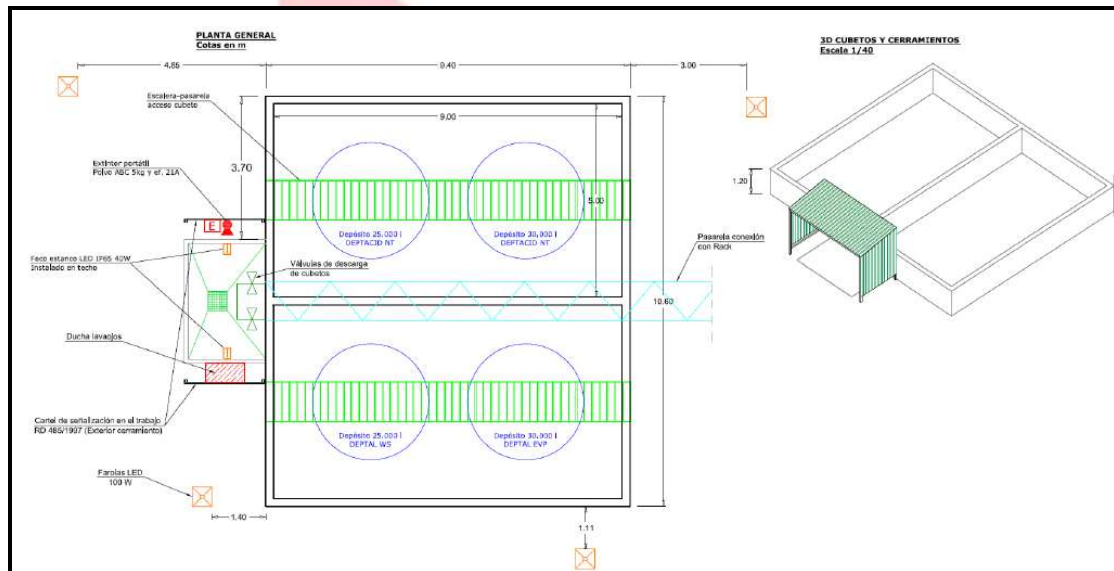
Vista en planta y 3D cubetos y cubierta para carga-descarga.
